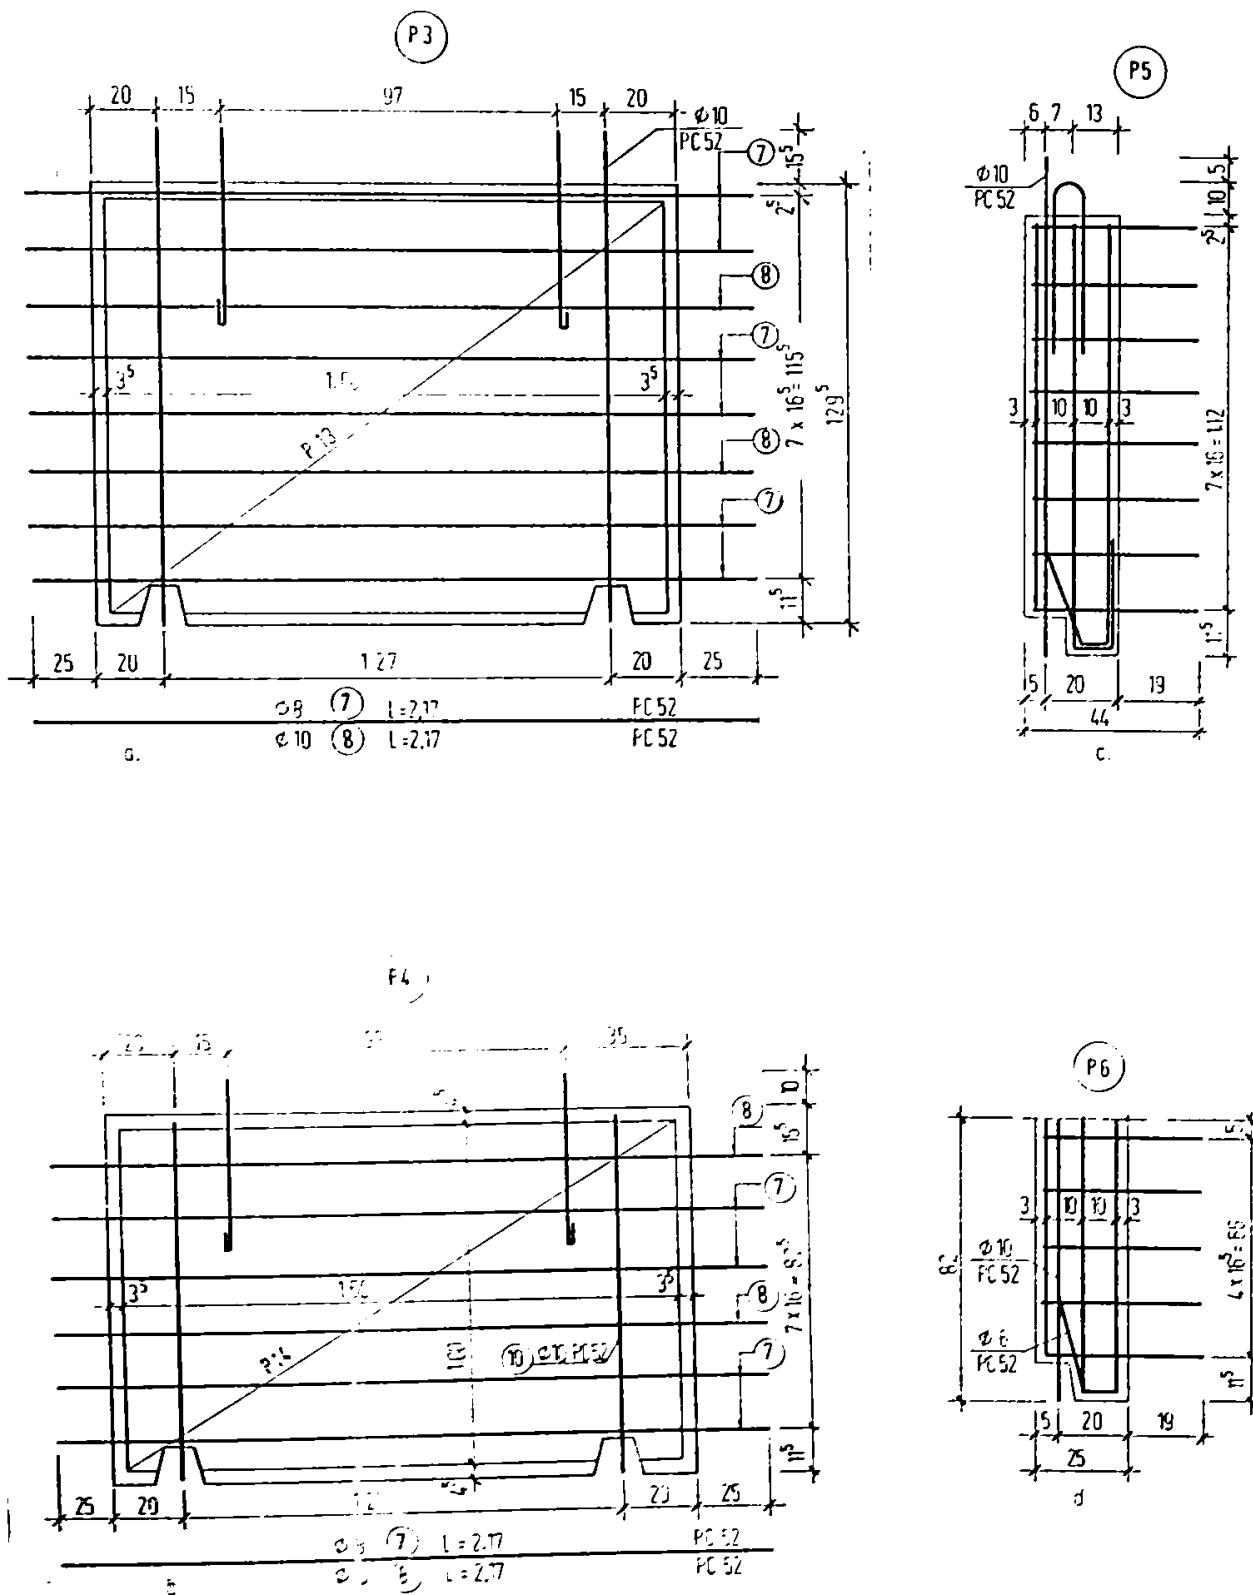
PERETE STRUCTURAL PREFABRICAT - MODEL F6 - ARMARE PANOURI
